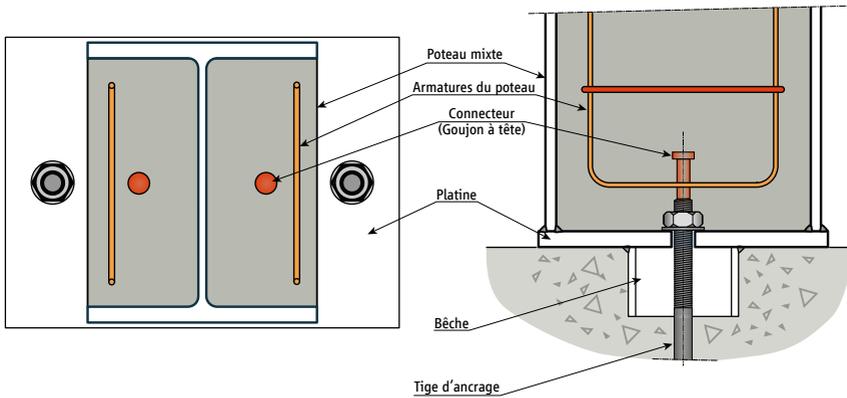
Pied de poteau mixte – Profilé partiellement enrobé – Platine simple
